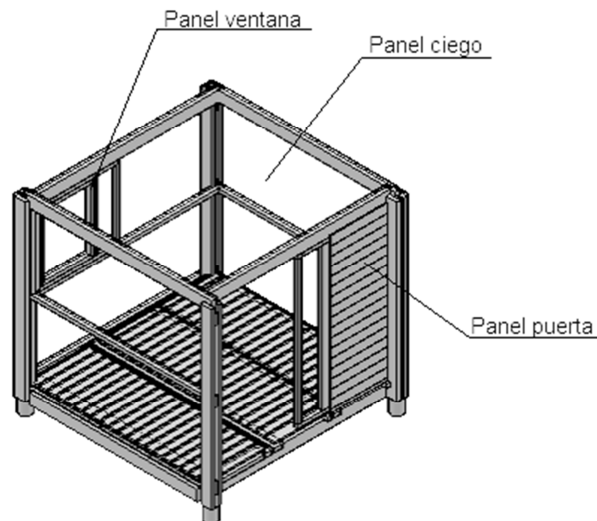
Esquema de la estructura resistente en conjunto con paneles puerta y ventana. Fuente: Documentación provista por TECHO.
